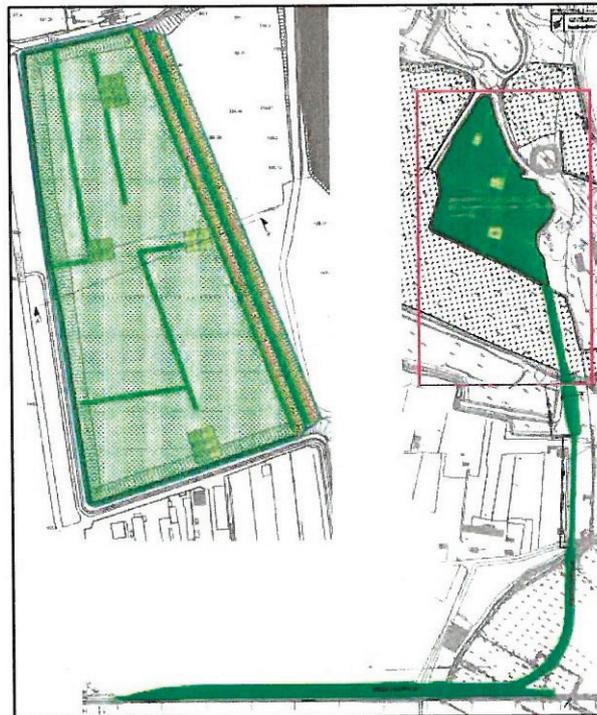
Sistemazione finale deposito e cantiere Torrazza
